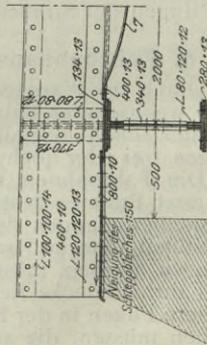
Beweglicher Fahrhauabschluß bei Kiesbettung.
